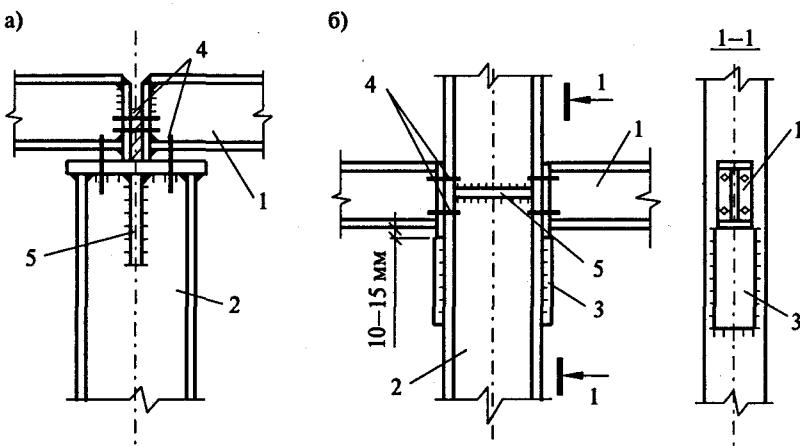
Шарнирное опирание балок на колонну: а) опирание на верх колонны; б) опирание на опорный столик; 1 — балка; 2 — колонна; 3 — опорный столик; 4 — болты; 5 — ребро жесткости
